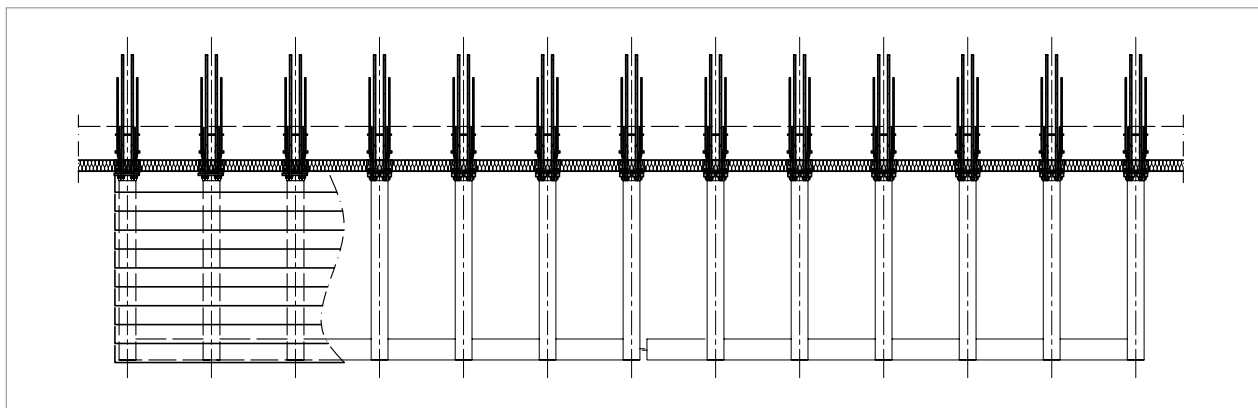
Schöck Isokorb® T type SK : balcon en porte-à-faux
